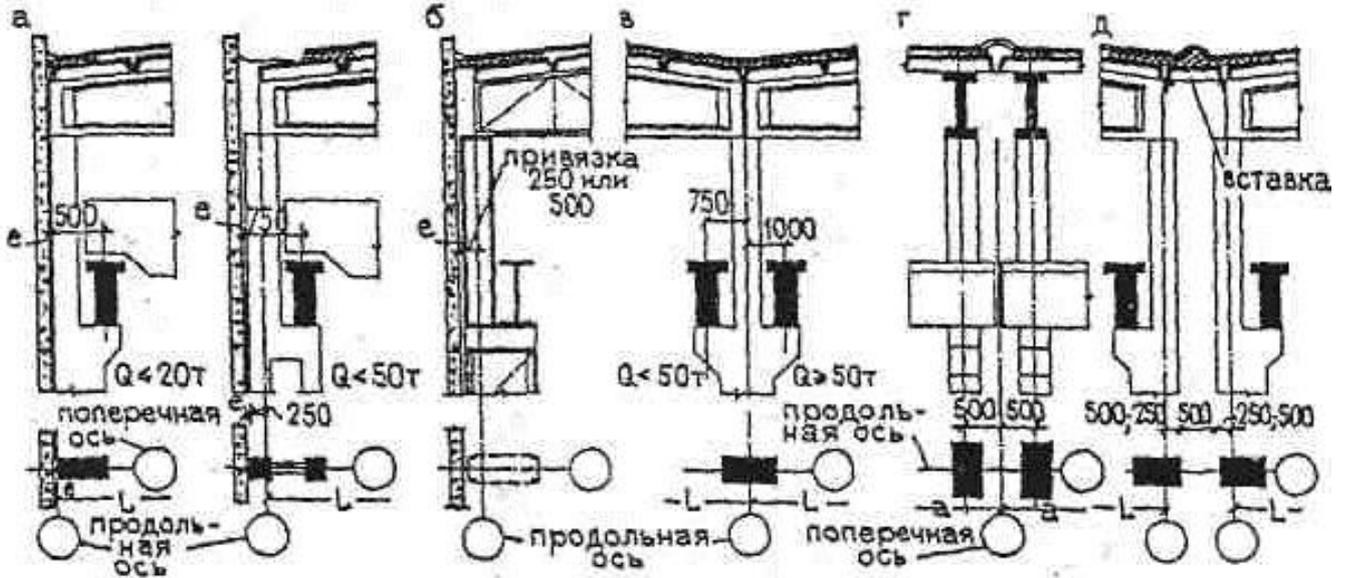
Привязка элементов к разбивочным осям зданий, оборудованных кранами: а - железобетонные колонны с шагом 6 или 12 м; б - стальные колонны; в - средние ряды колонн; г - поперечный температурный шов; д - продольный температурный шов.
